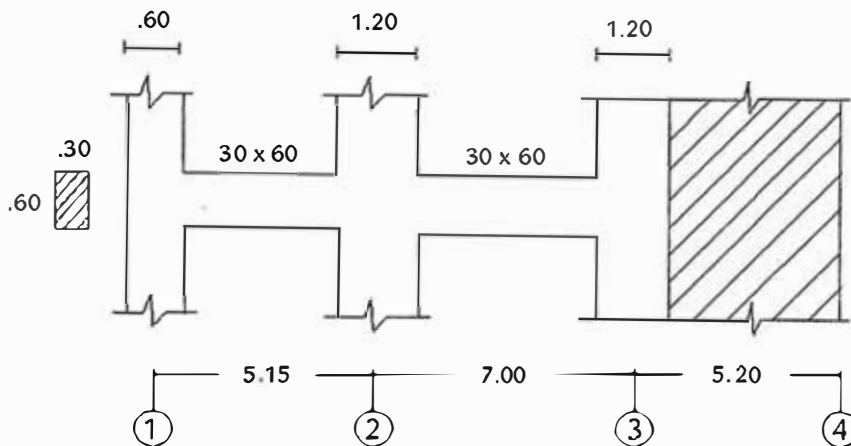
Esquema de la viga correspondiente al pórtico D en el primer nivel
